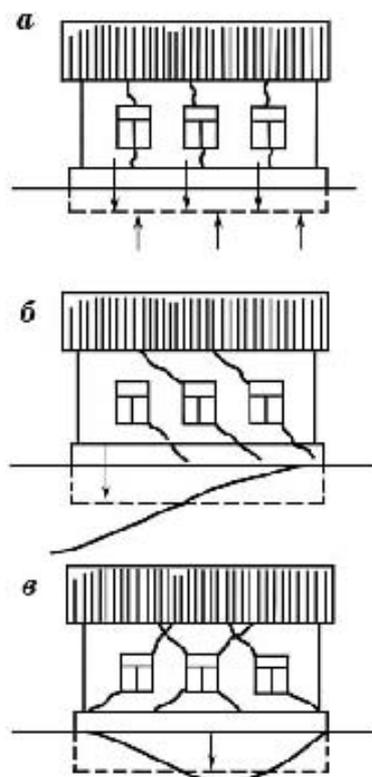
Деформации малоэтажных жилых зданий, возведенных на просадочных грунтах: а - в результате жестких усилий утяжеленного фундамента и грунта (искривление здания выпуклостью вверх (выгиб) с образованием вертикальных трещин в верхней части стен). Подобная деформация возможна от сейсмического воздействия; б - искривление здания выпуклостью вниз от усилия изгиба или прогиба наподобие косога среза (от проседания грунта); в - от местного сжатия по центру здания (просадка) перекрестные трещины, косые сдвиги слева направо и справа налево. В частности зависят от прочности нижних слоев грунта.
